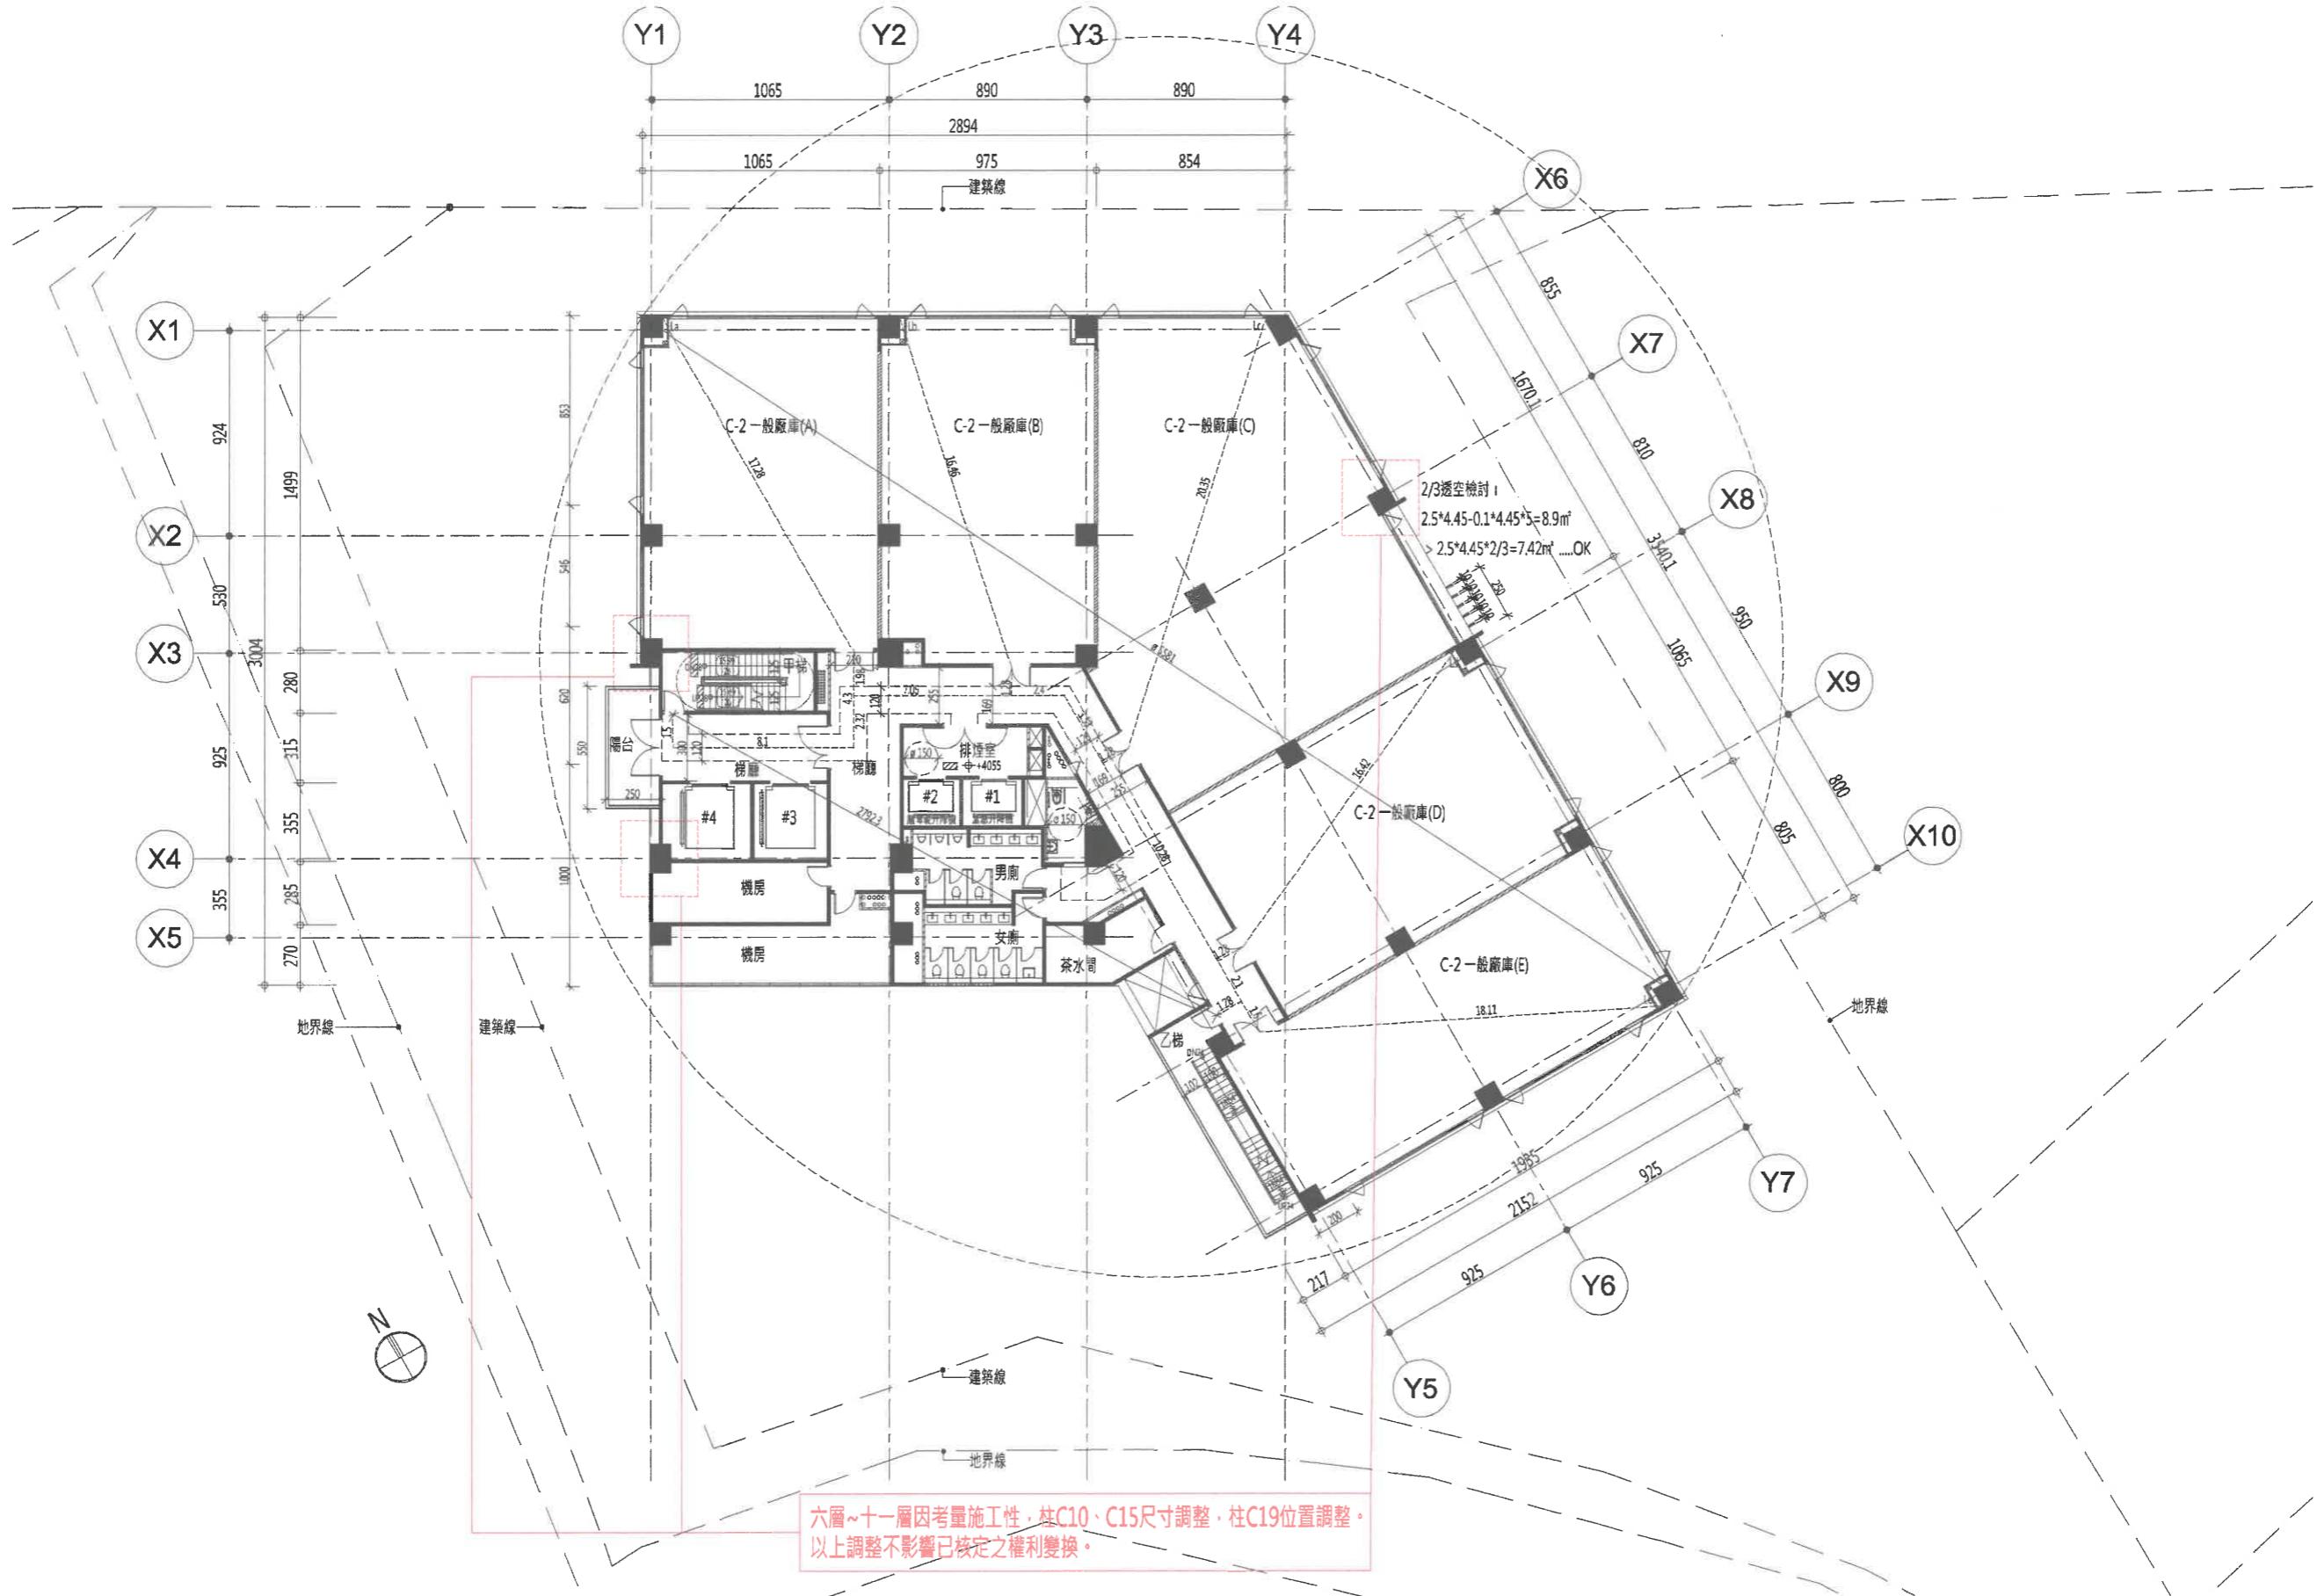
地上十層平面圖(原核定)(S : 1/300)
